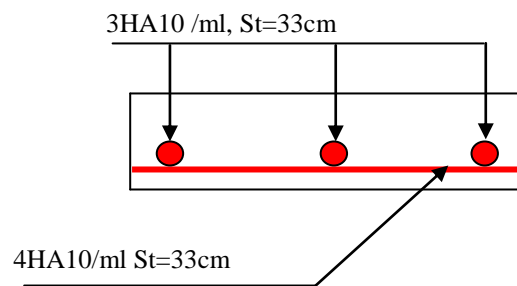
Schéma de ferrailage d'une dalle sur deux appuis
